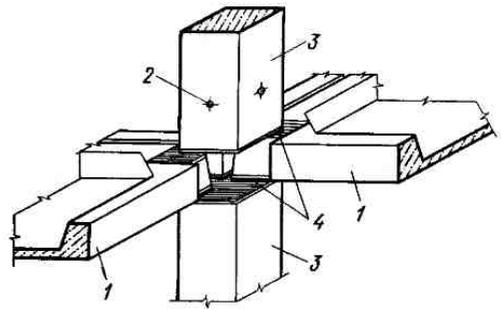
Конструкция стыка колонны с панелями перекрытий при безригельном каркасе:
